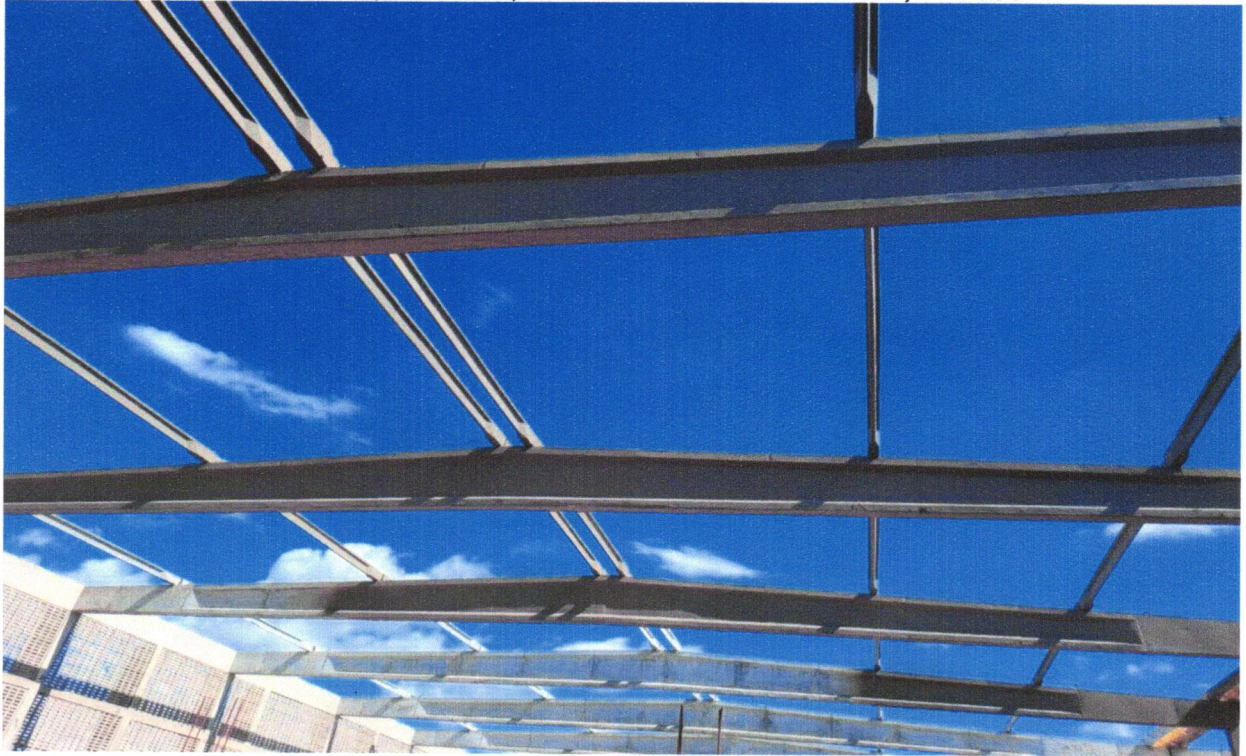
TRAMA DE AÇO COMPOSTA POR TERÇAS PARA TELHADOS DE ATÉ 2 ÁGUAS PARA TELHA ONDULADA DE FIBROCIMENTO, METÁLICA, PLÁSTICA OU TERMOACÚSTICA, INCLUSO
